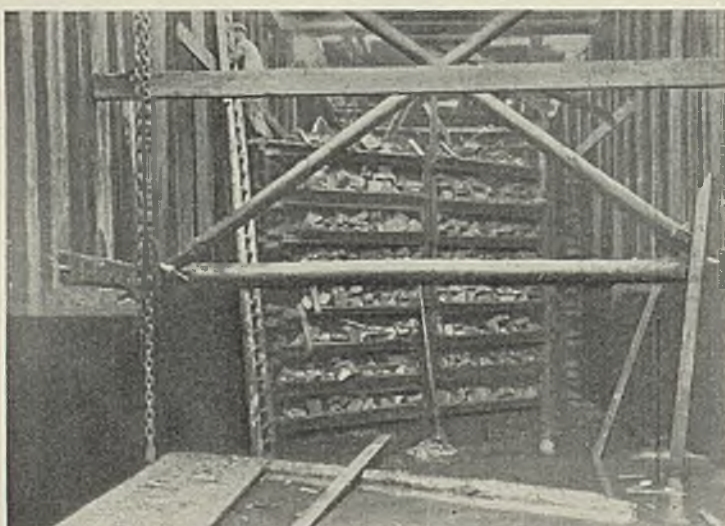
Pfeilerschalung mit Ballaststeinen nach dem Leerpumpen der Baugrube.
